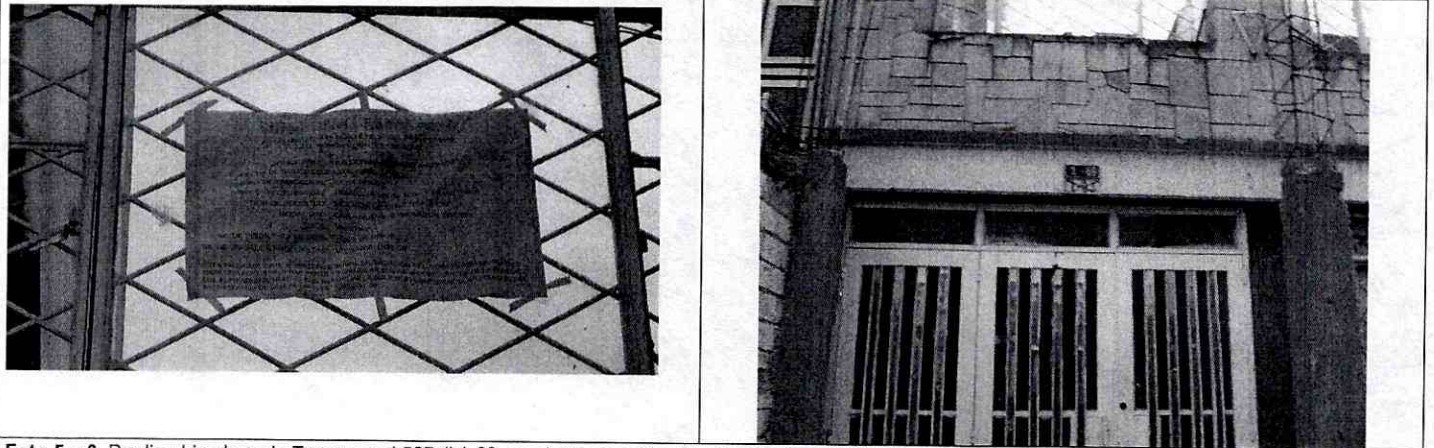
y 6. Predio ubicado en la Transversal 52B # 1-69, en el que se está adelantando demolición y construcción.
